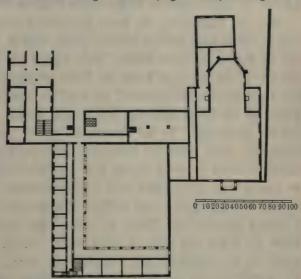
Landsberg, Kolleg mit Kirche. Grundriß. (Nach Originalgrundriß.)
